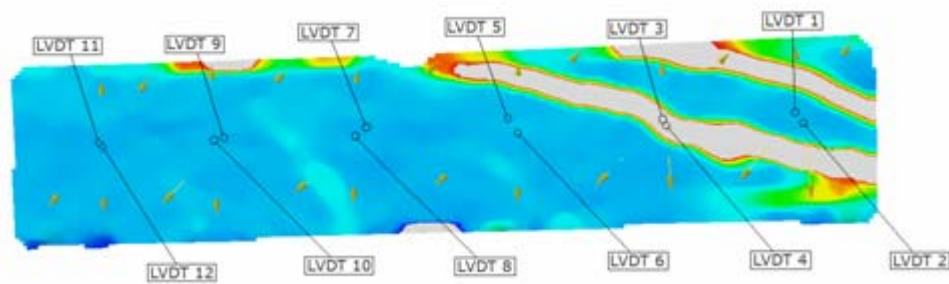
Image des déformations de la face Ouest, travée Sud – Essai 2
